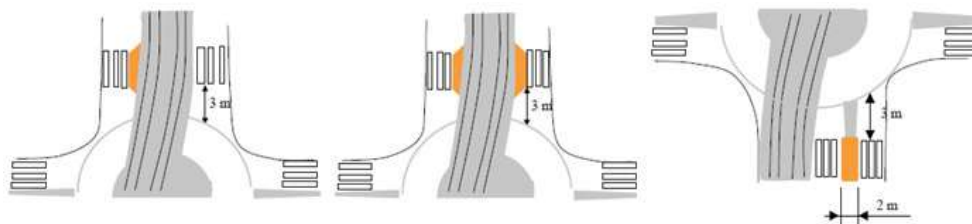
Traversées piétonnes par rapport au type d'insertion. Source : Giratoires et tramways, guide de conception Certu et STRMTG, 2008.
